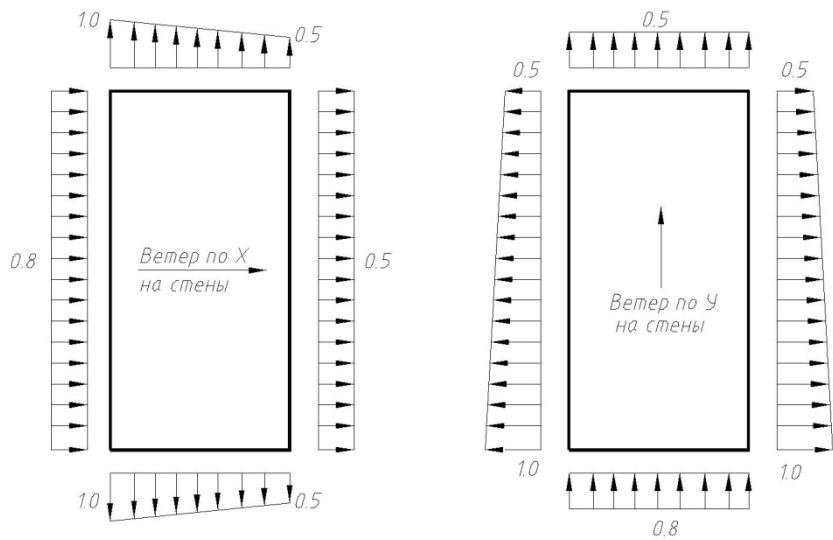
Схема приложения ветровой нагрузки на стены
